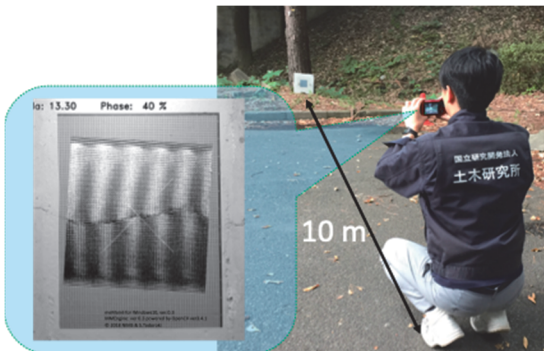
遠隔からのモアレ縞によるひび割れ部検出例
